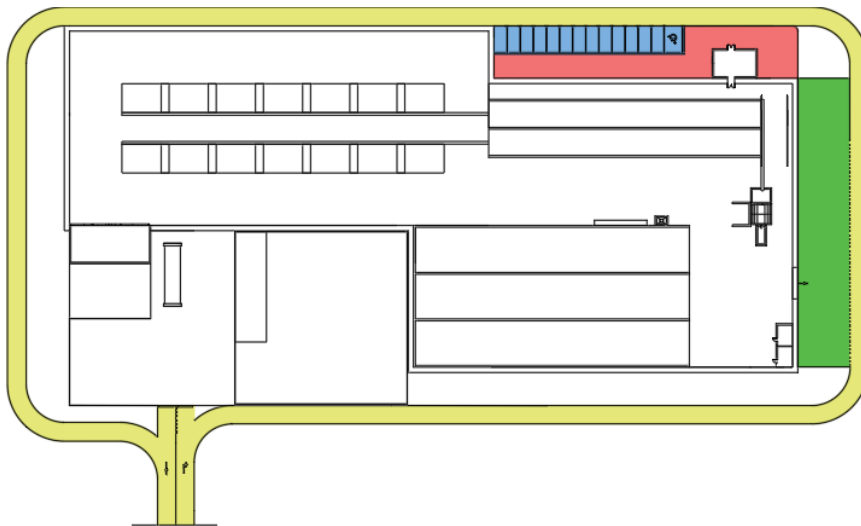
Disposición de la planta, Opción 2. Fuente: Elaboración propia
